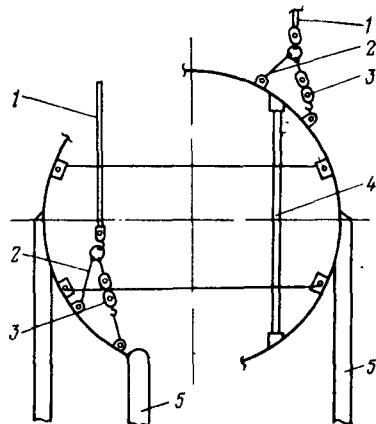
Схема сборки лепестков шарового резервуара:
